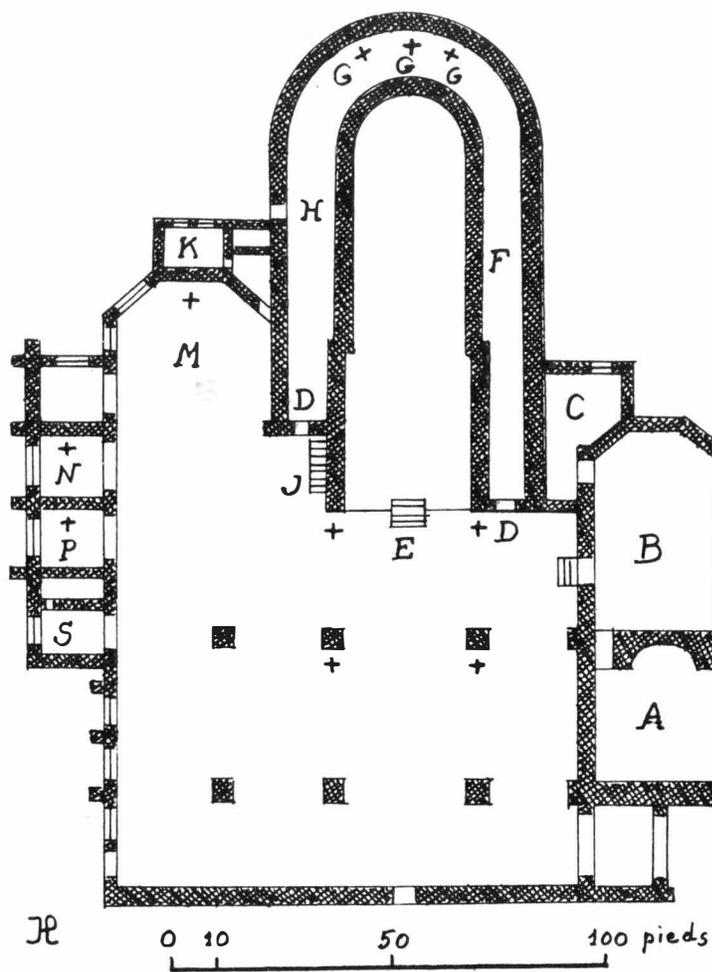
Plan de St-Pierre de Douai, 1734.
